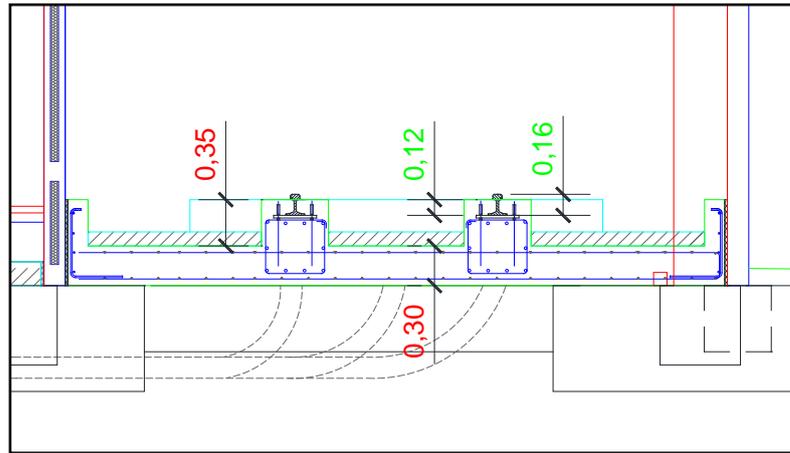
sección transversal de la cimentación para el apoyo del autotransformador.
